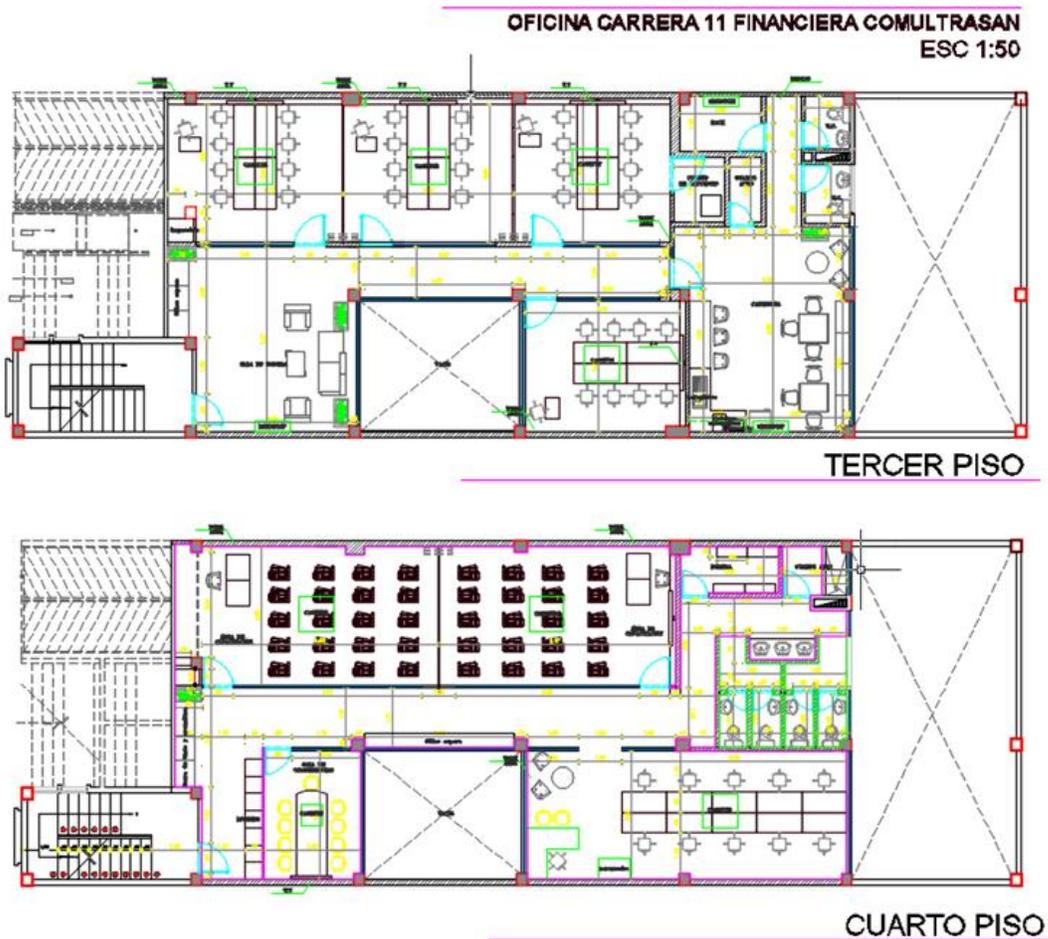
Plano planta piso 3 y piso 4 edificio Carrera 11.
